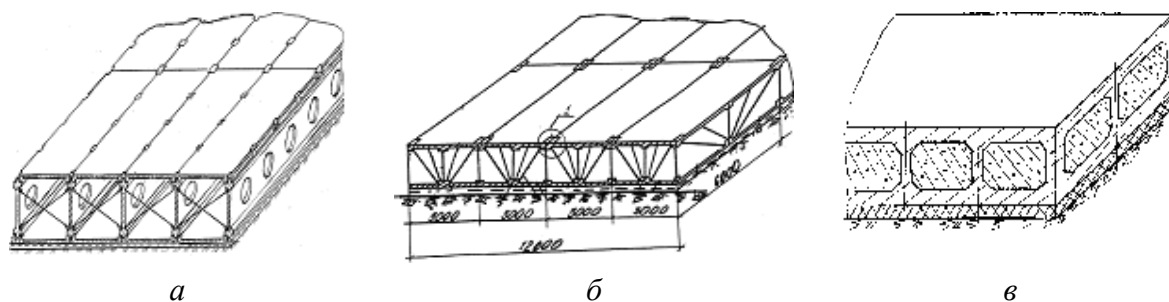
Пространственные фундаментные платформы для строительства на слабых и вечномёрзлых грунтах и в сейсмических районах: *а* – сборная железобетонная платформа (патент РФ № 38789); *б* – сборная сталежелезобетонная фундаментная платформа (патент РФ № 2206665); *в* – монолитная фундаментная платформа с утеплителем (патент РФ № 45410)
